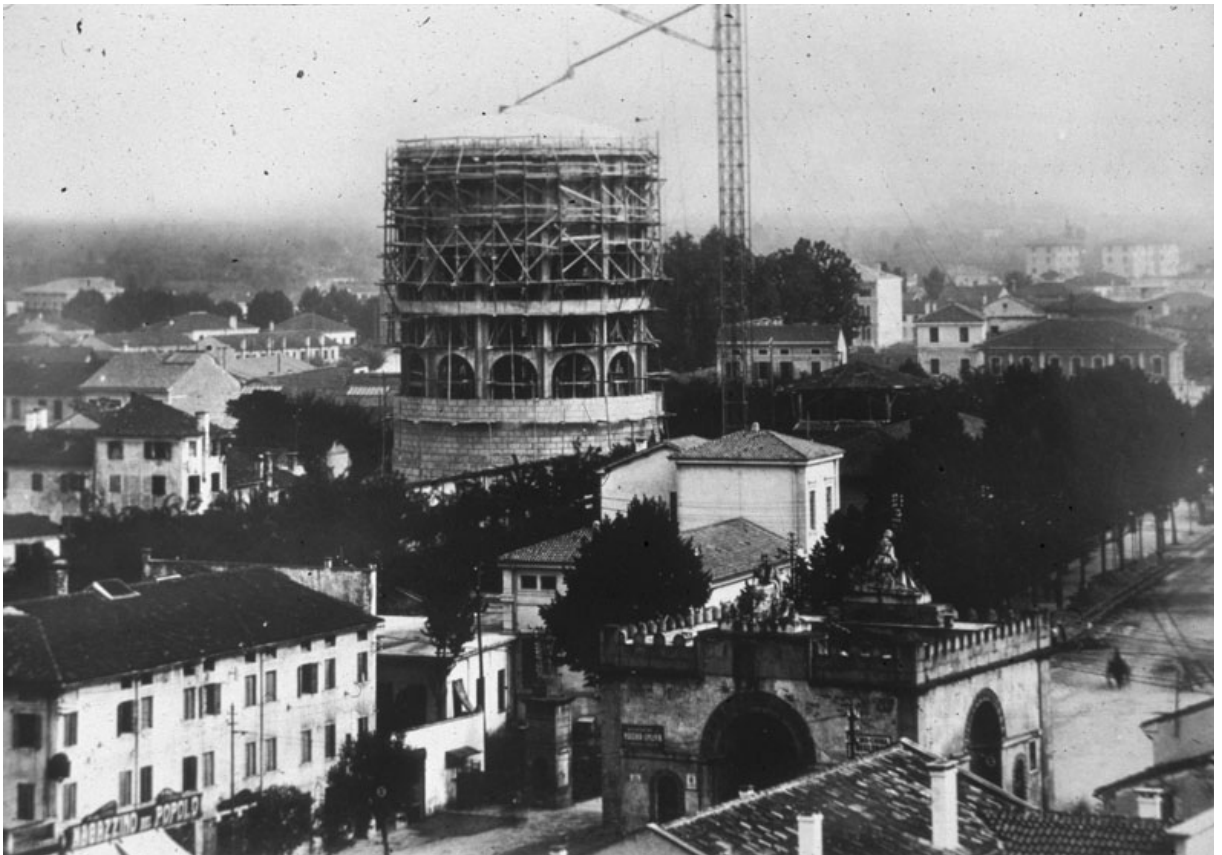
Serbatoio La Rotonda dell'acquedotto di Padova, fase di costruzione.
